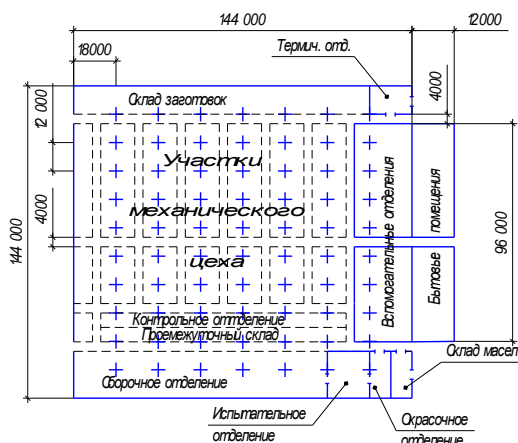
Пример компоновки корпуса механосборочного цеха
